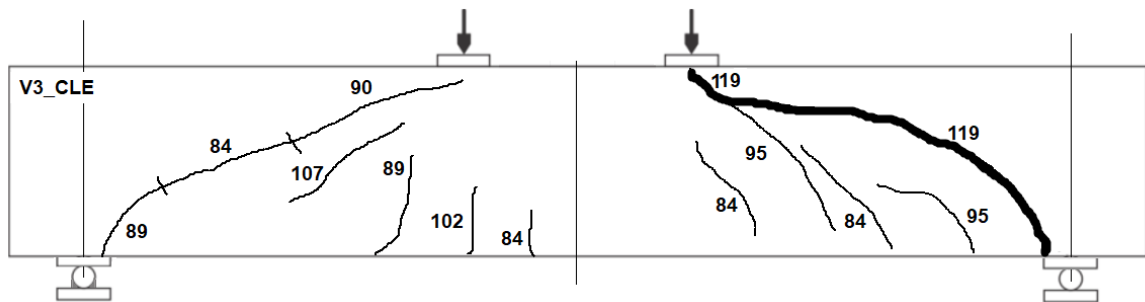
Esquema de fissuração da Viga 3_CLE.
